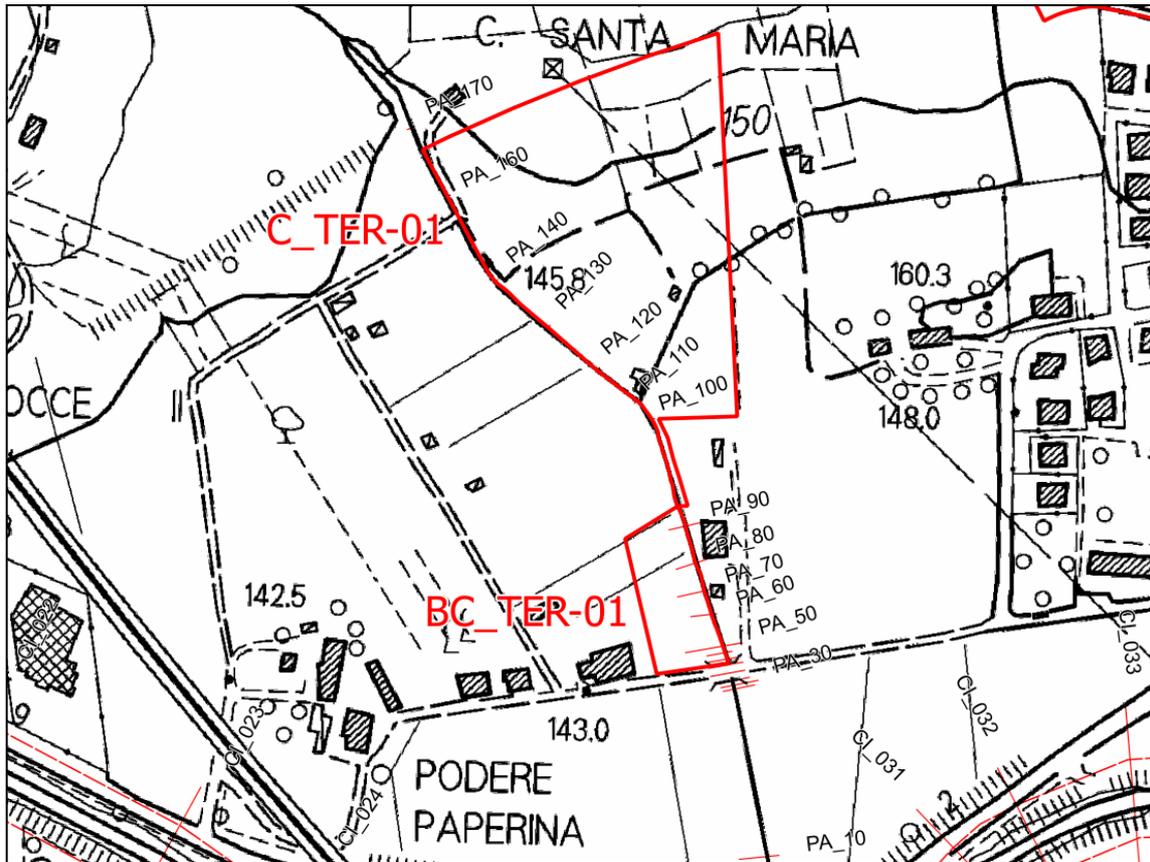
Fosso Paperina - planimetria sezioni trasversali.
